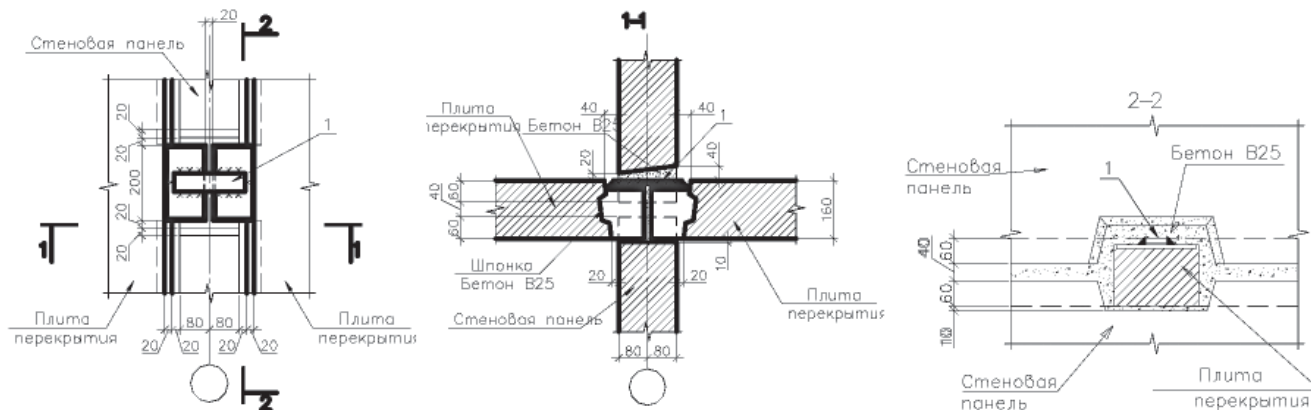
Горизонтальный стык шпоночного сопряжения плит перекрытий и стен
